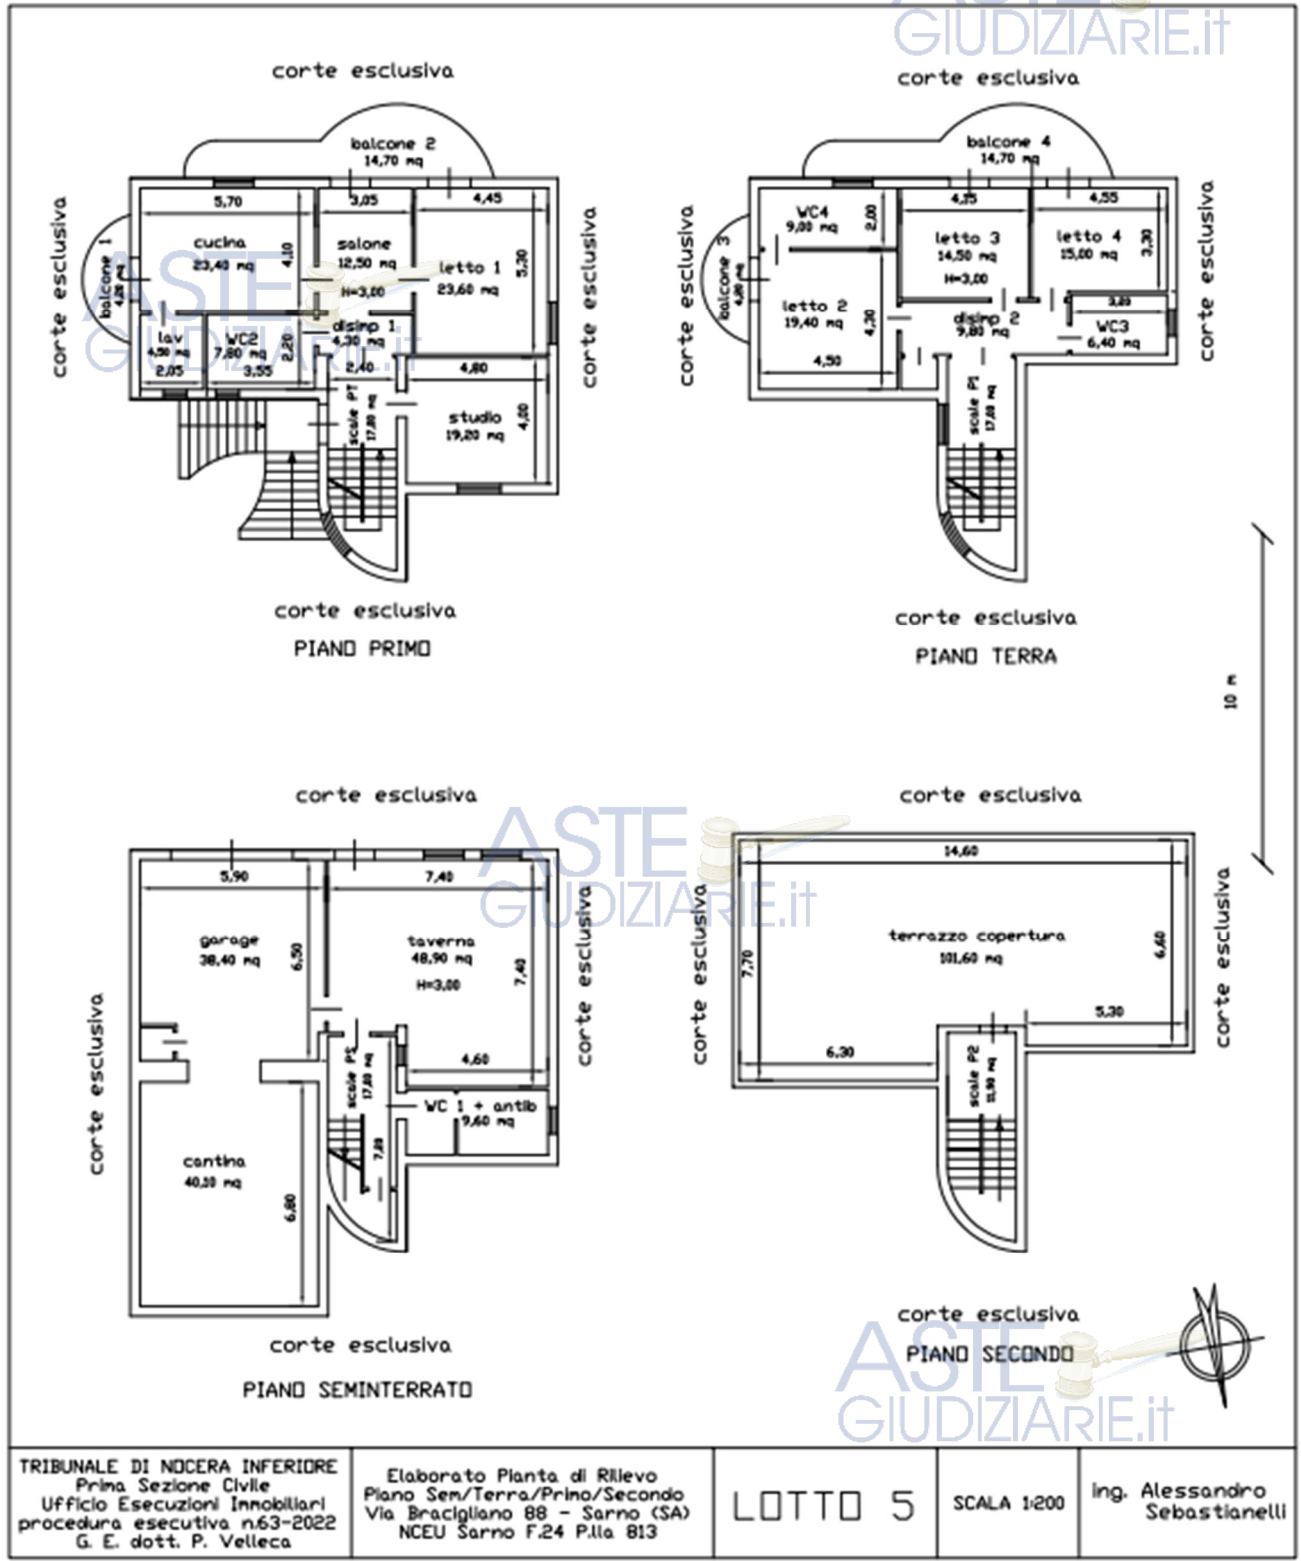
Planimetria stato di rilievo appartamento pignorato lotto 5 (F.24 p.IIa 813)
